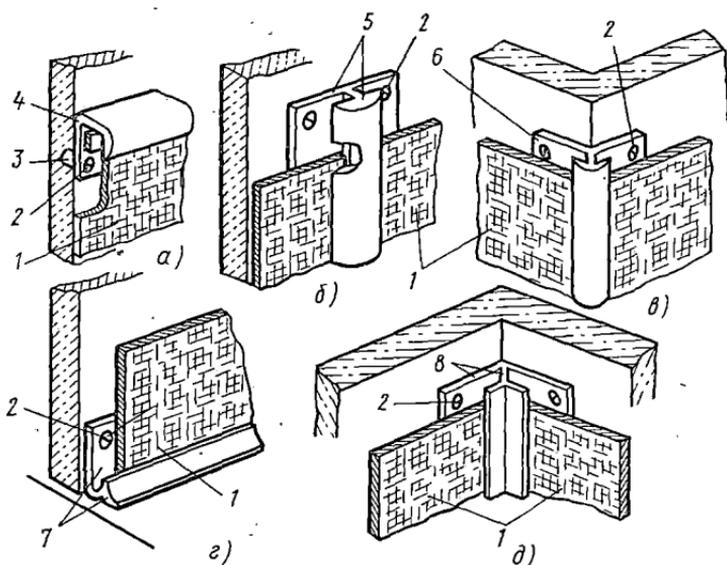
Закрепление раскладками крупноразмерных облицовочных изделий:
